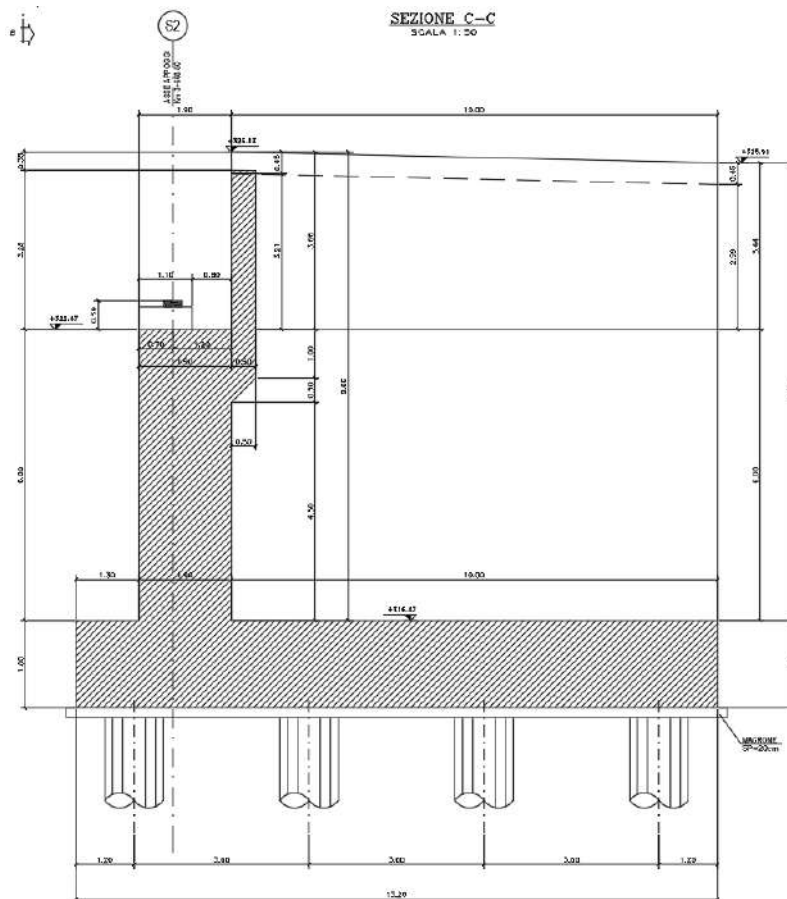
Sezione longitudinale Spalla 2
